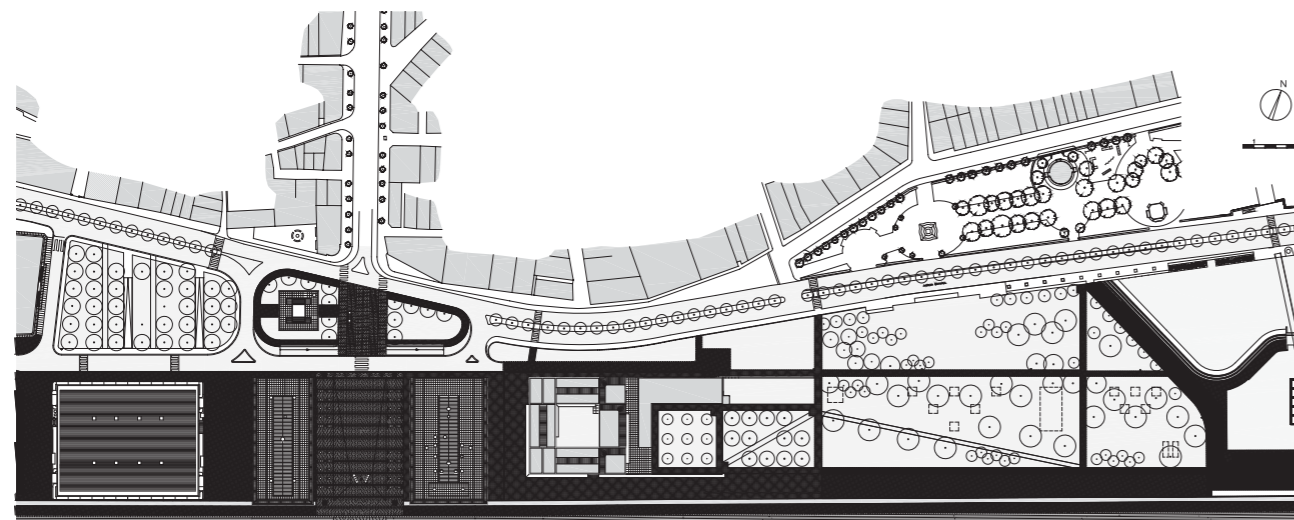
Planta de implantação da frente ribeirinha de Viana do Castelo.
